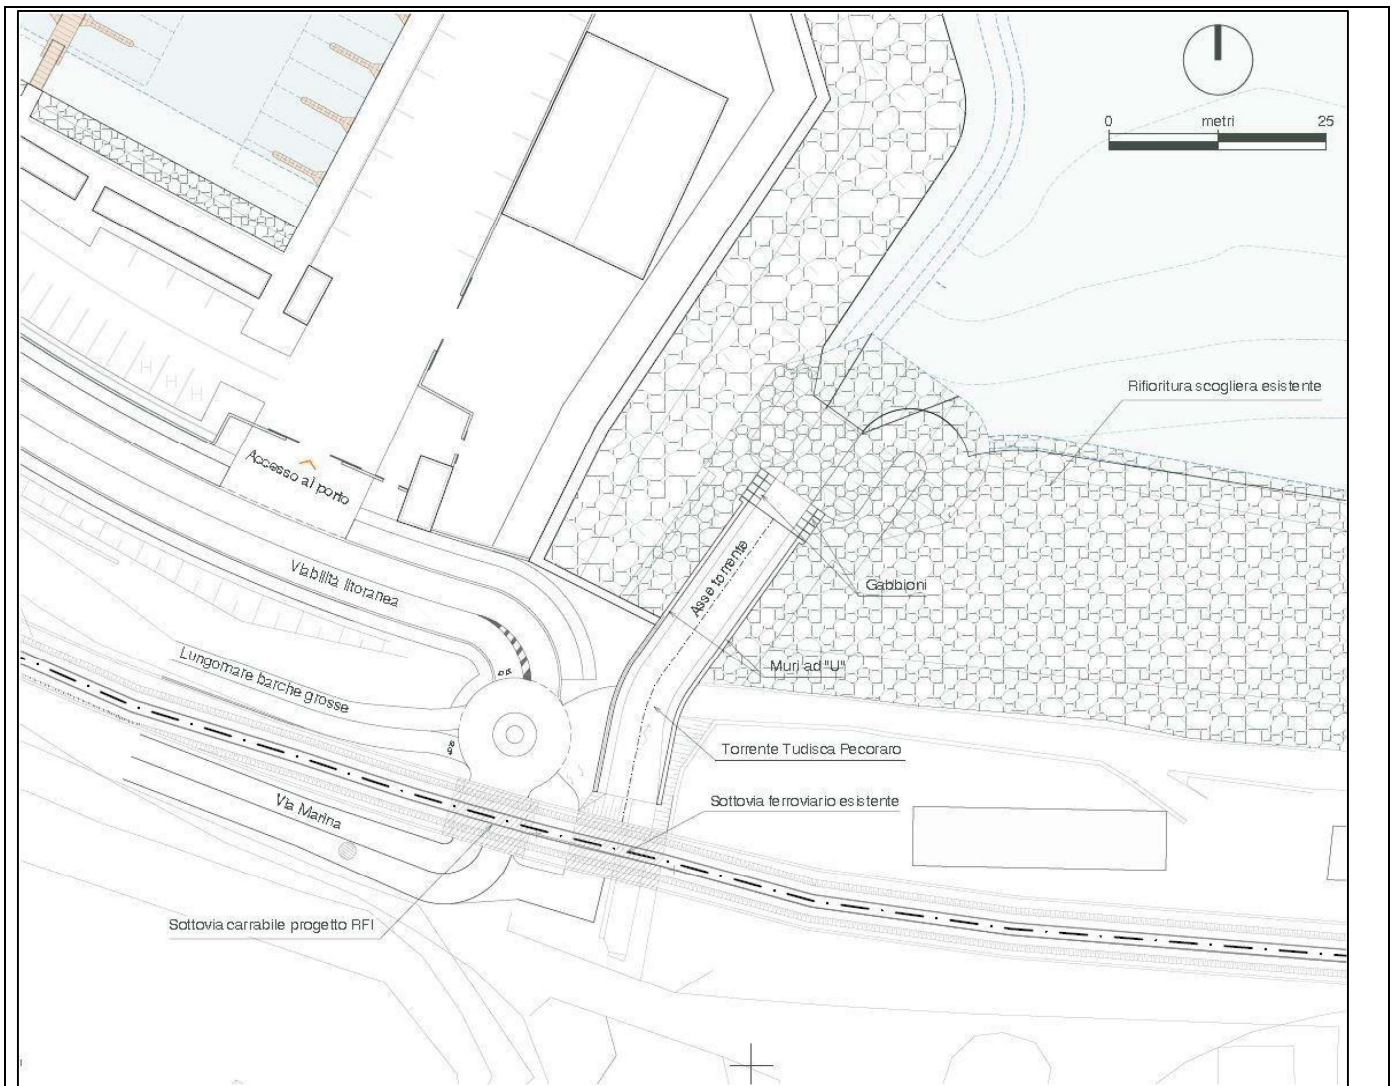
Vallone Tudisca - soluzione di progetto – Planimetria assetto finale della viabilità.
